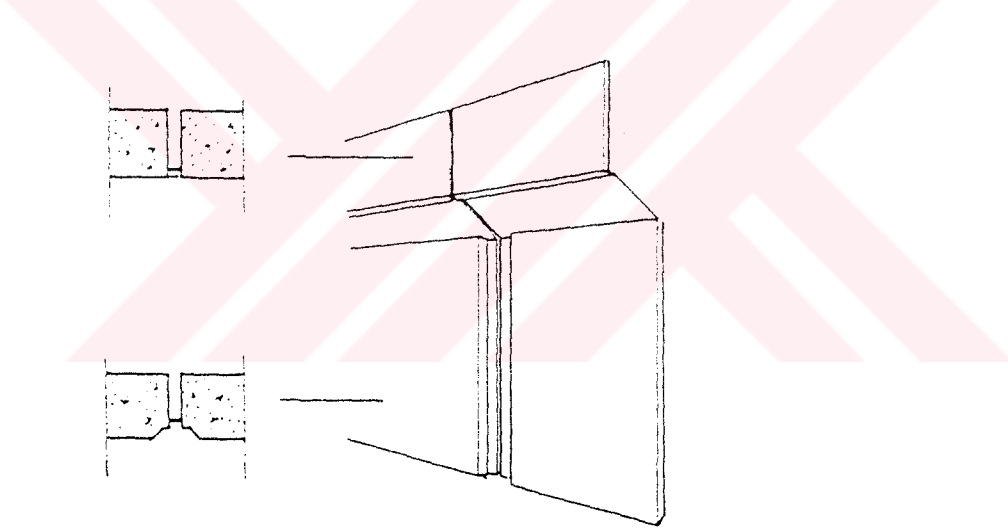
'da tüm yönlerden hava etkilerine açık bir parapet elemanının tek aşamada yalıtılmış fuga oluşumu gösterilmiştir. Parapet fugalarının su geçirimsizliği önemli olduğundan, saç harpuşta macunun (contanın) ömrünü uzatacaktır. Ancak parapet fugalarının düzenli olarak kontrolünü ve bakımını yapmak gerekmektedir.
